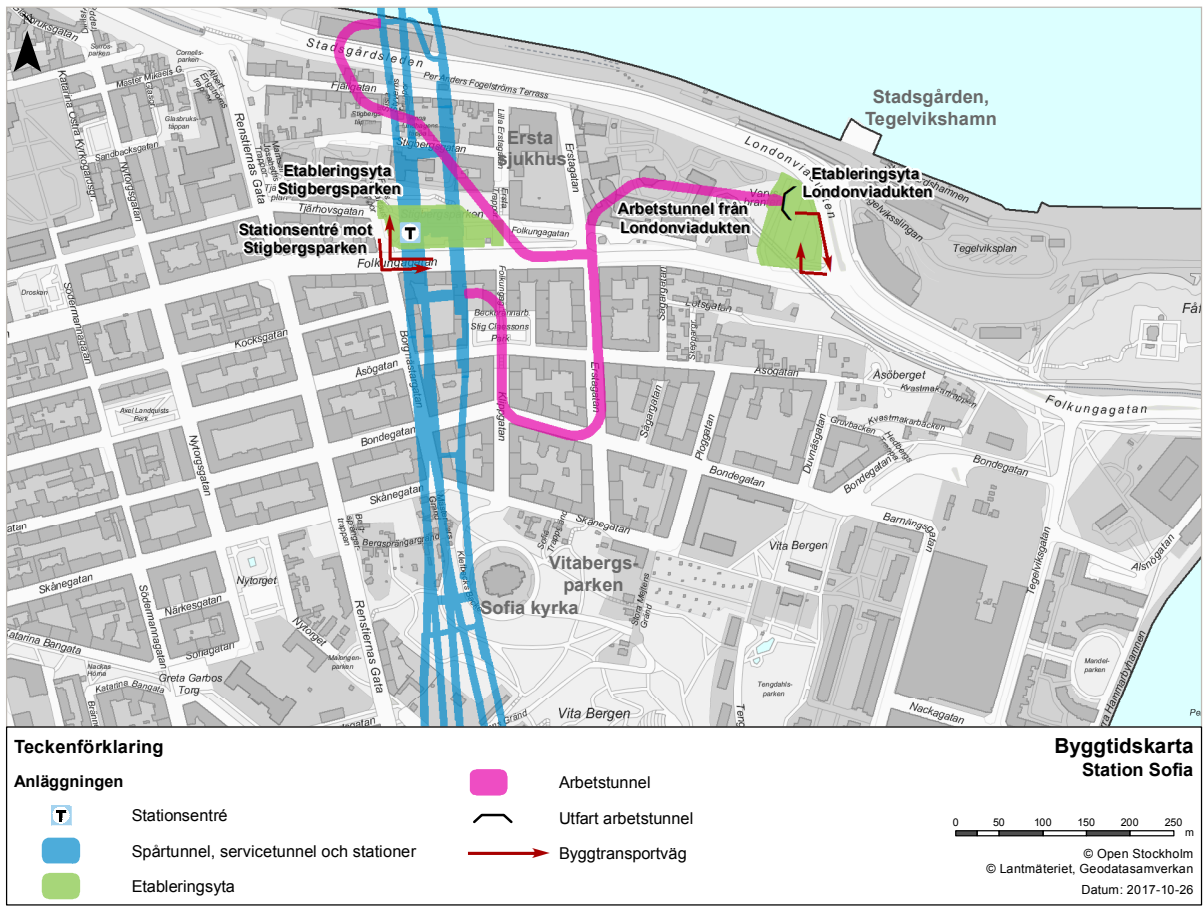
b Station Sofia, situationsplan, som visar den planerade stationen och planerad omdaning av Stigbergsparken.
